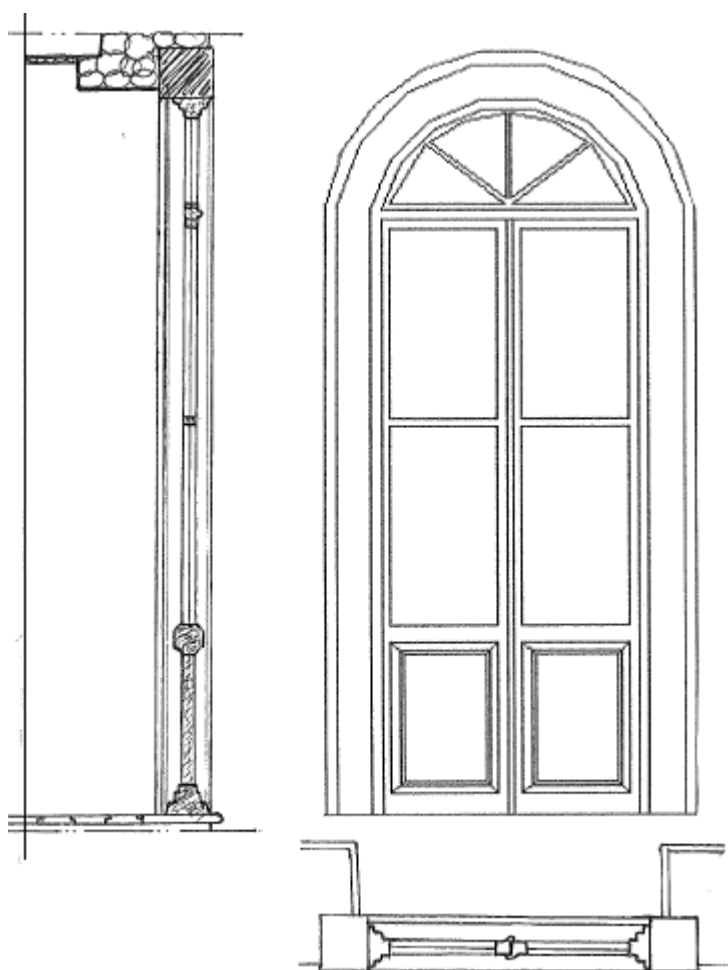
Caixilharia em madeira de uma janela de sacada e batente (duas folhas e bandeira fixa), com verga em arco pleno - corte vertical, corte horizontal e alçado exterior.
